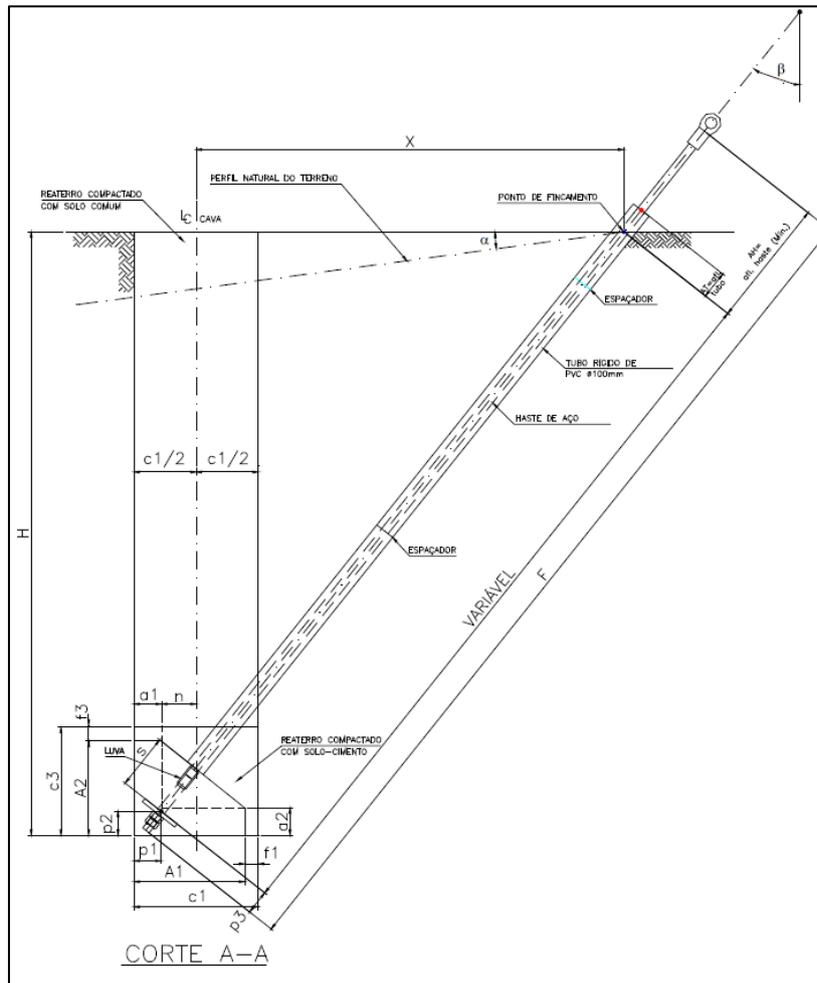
Viga pré-moldada para os estais com vista em corte.
